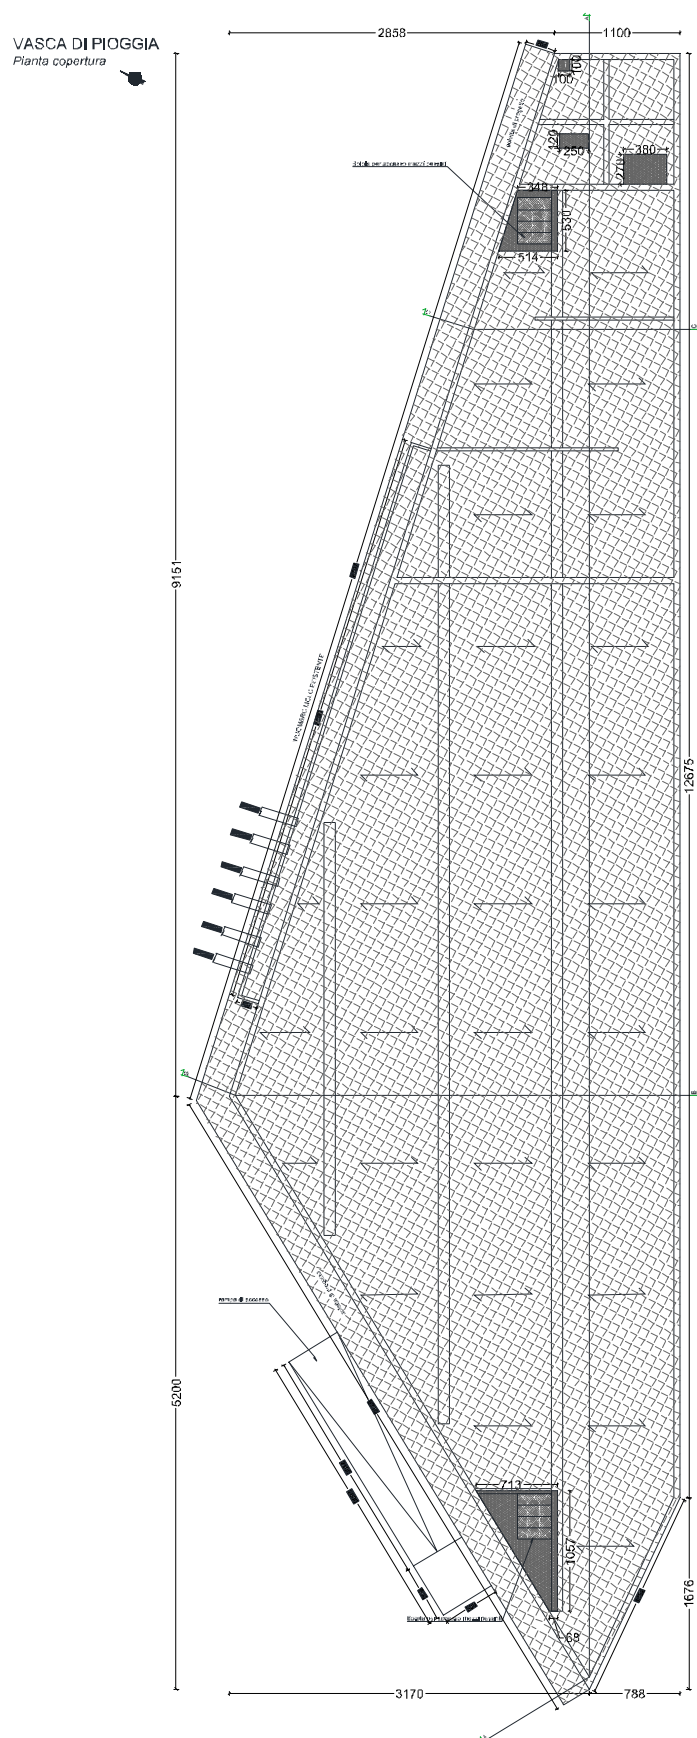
Architettonico, pianta orditura solaio di copertura
